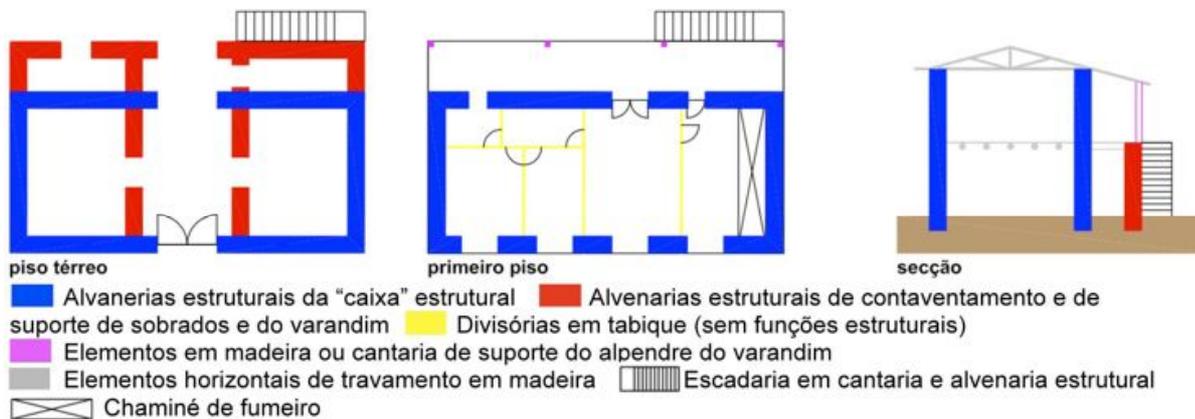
Esquema estrutural da casa tipo da área de estudo
